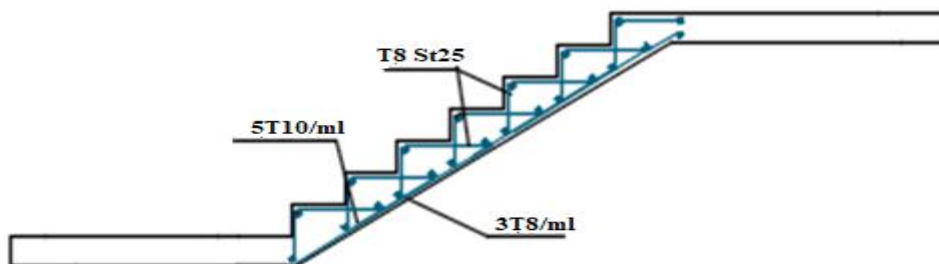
Schéma de ferrailage de l'escalier (volée2).
